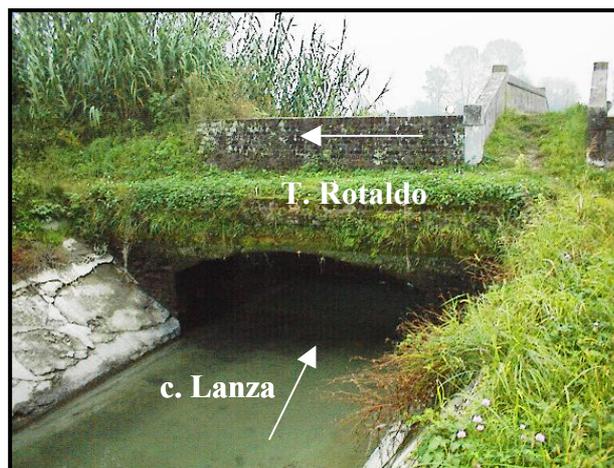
Vista da monte del primo ponte sul canale Lanza e dell'attraversamento del Rotaldo.
